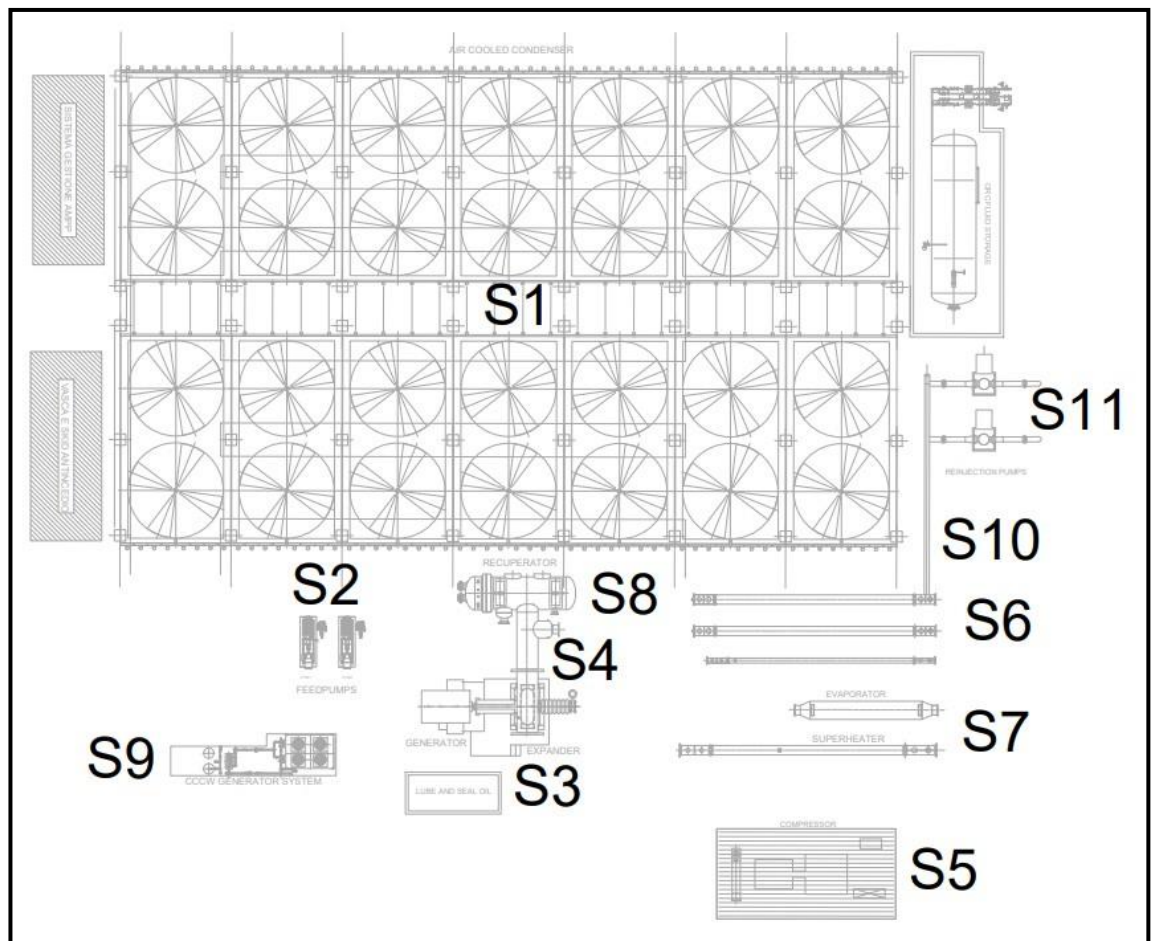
a Planimetria dell'impianto ORC in progetto ed individuazione delle sorgenti sonore
